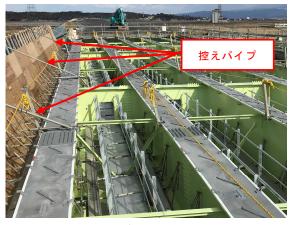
控えパイプの設置状況 (藤塚こ道橋)
